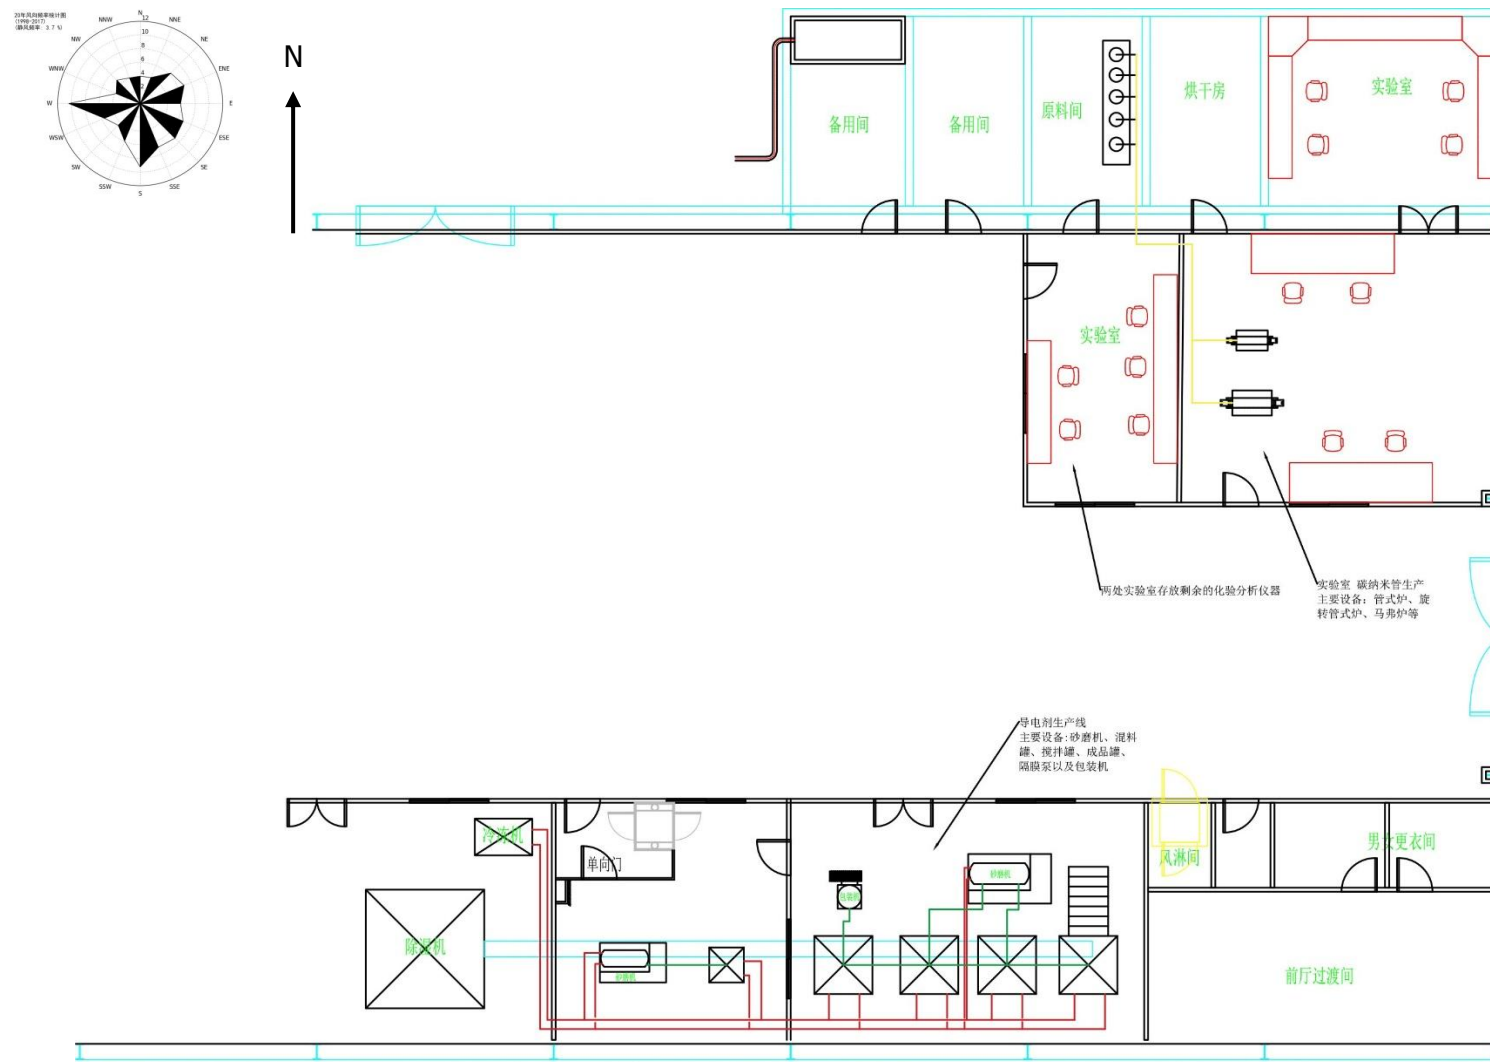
拟建项目车间平面布置情况 (1:120)
